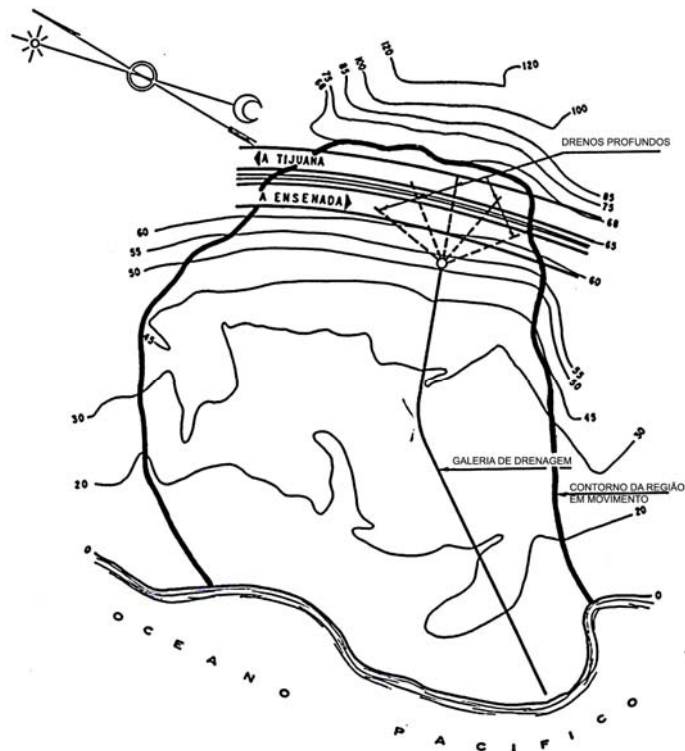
Planta da galeria de drenagem construída no km 19+200 da Rodovia Tijuana-Enseada (Rico e Castilho, 1974).
